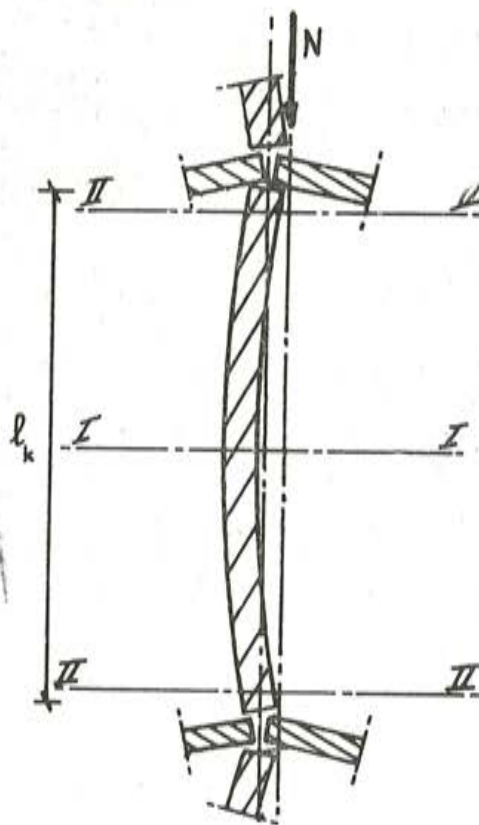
Cálculo de las secciones del muro bajo carga excéntrica:
